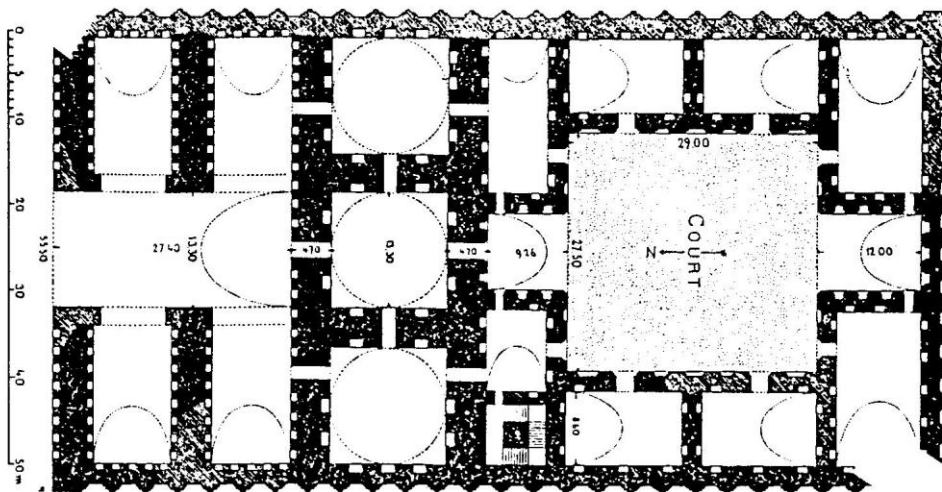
Firuzabad, Palast Ardasirs I, Grundriß
